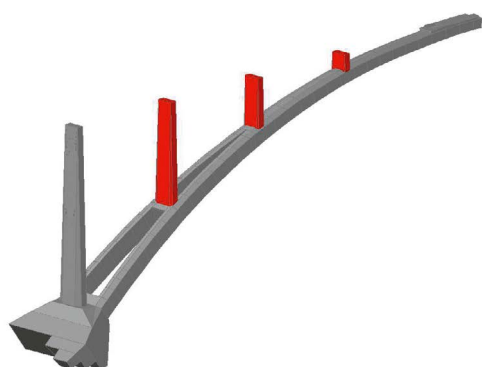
Recreación en 3D de las pilastras sobre el arco.
